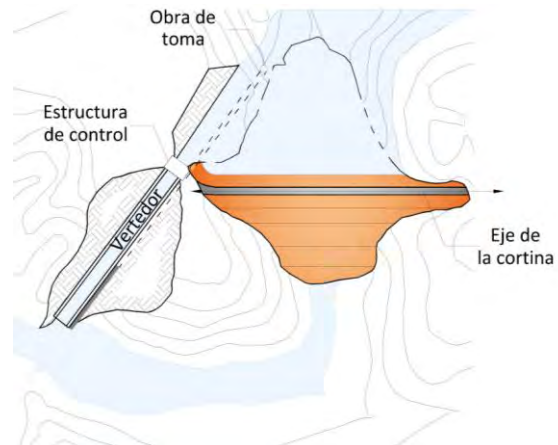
Dibujo en planta de una presa con vertedor en canal.
